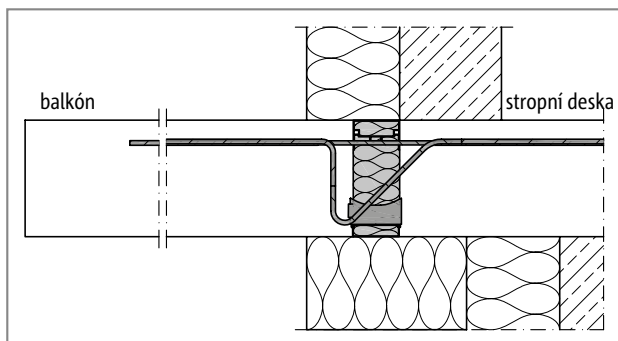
Schöck Isokorb® typ K a K-VV: Balkón uložný ze dvou stran
